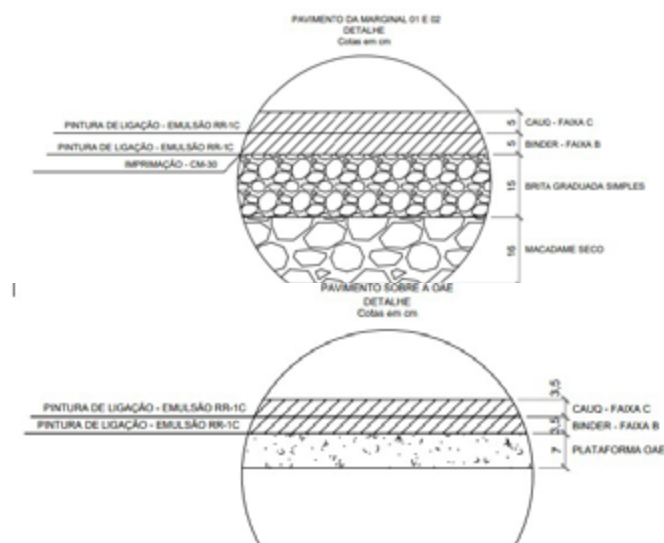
Projeto Pavimentação (Anteprojeto “Trevo Catuaí”, 2021).
